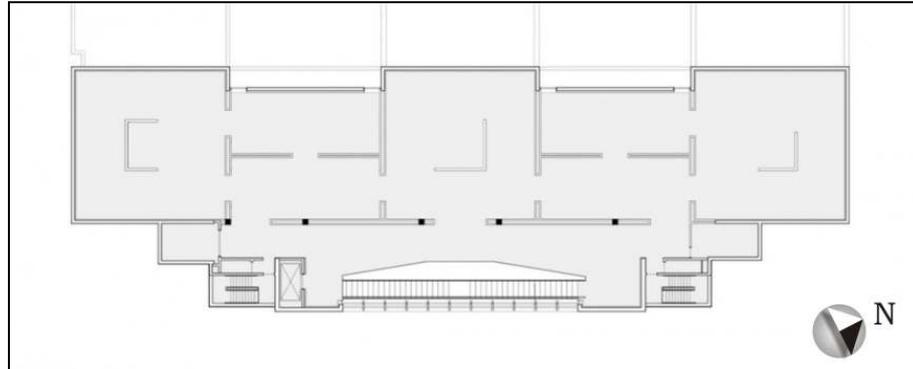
Planta baixa do terceiro pavimento (BASULTO, 2009).
